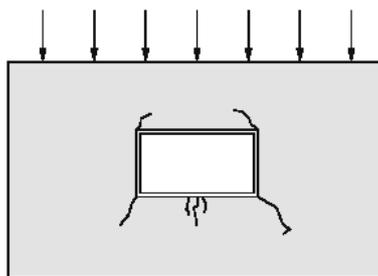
Fissuração teórica no contorno de abertura, em parede solicitada por actuação excessiva de cargas
